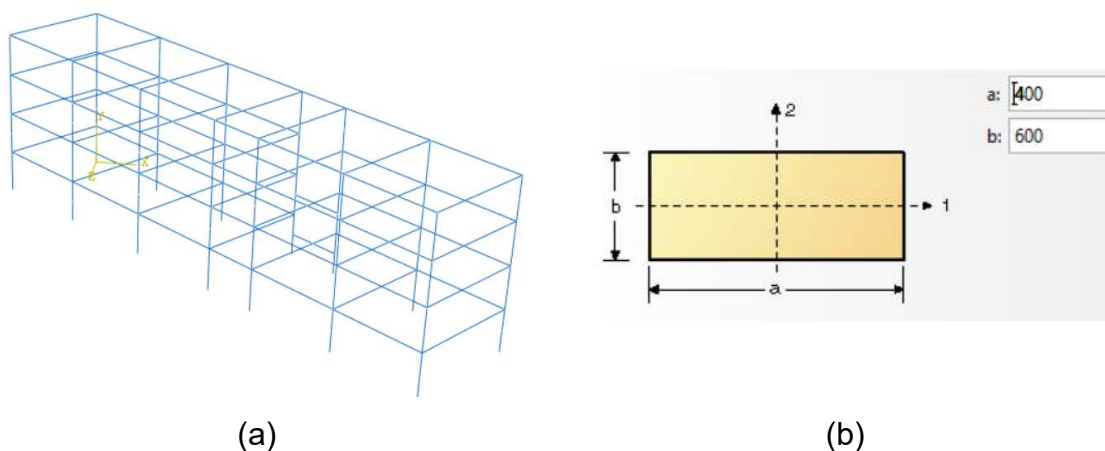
a) Columnas principales representadas como elementos tipo viga; b) Perfil de los elementos tipo viga.
